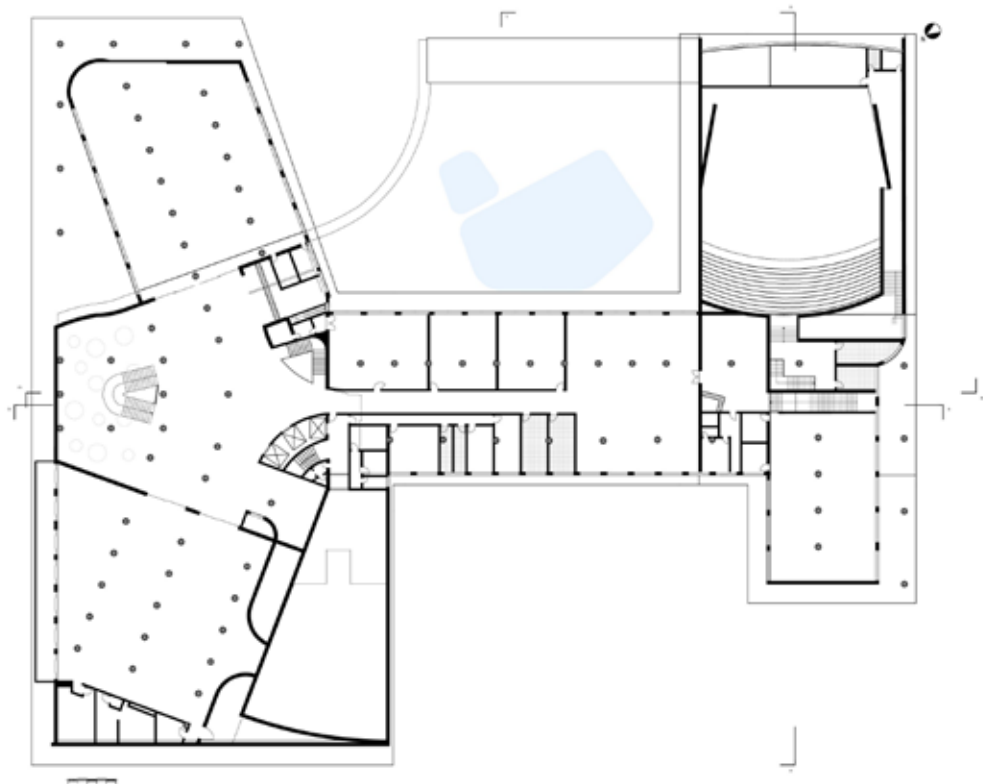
Planta Sobreloja Imperial Palace Hotel (1964), retirada da planta original
